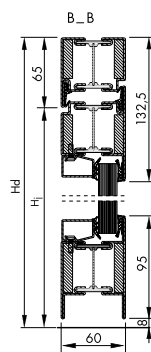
Coupe verticale d'une porte coupe-feu à un battant EI 30.
